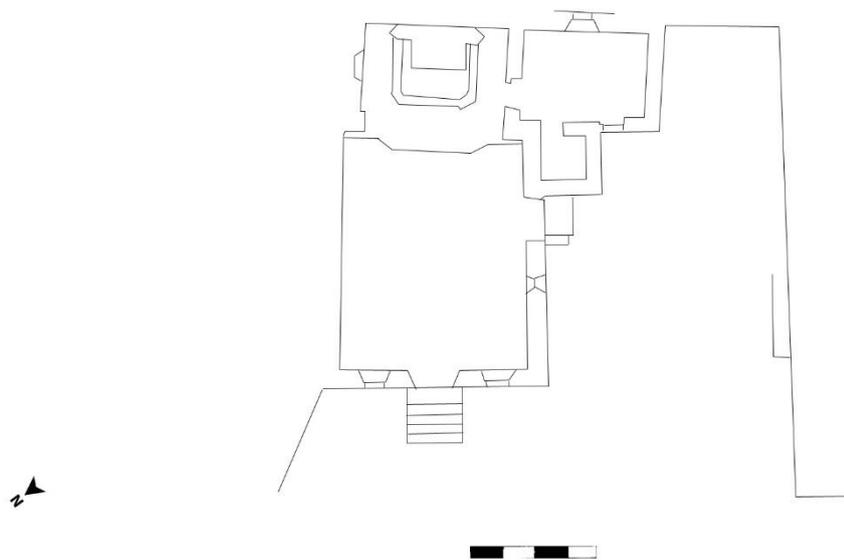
Planimetria della chiesa di Santa Caterina⁸⁰
